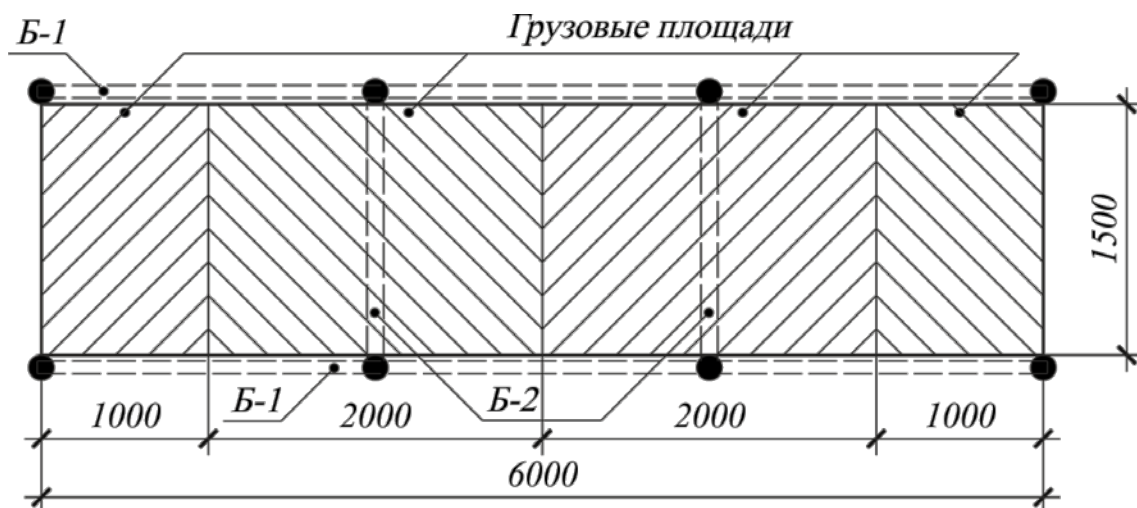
Схема распределения нагрузки на балки усиления Б-1 и Б-2
